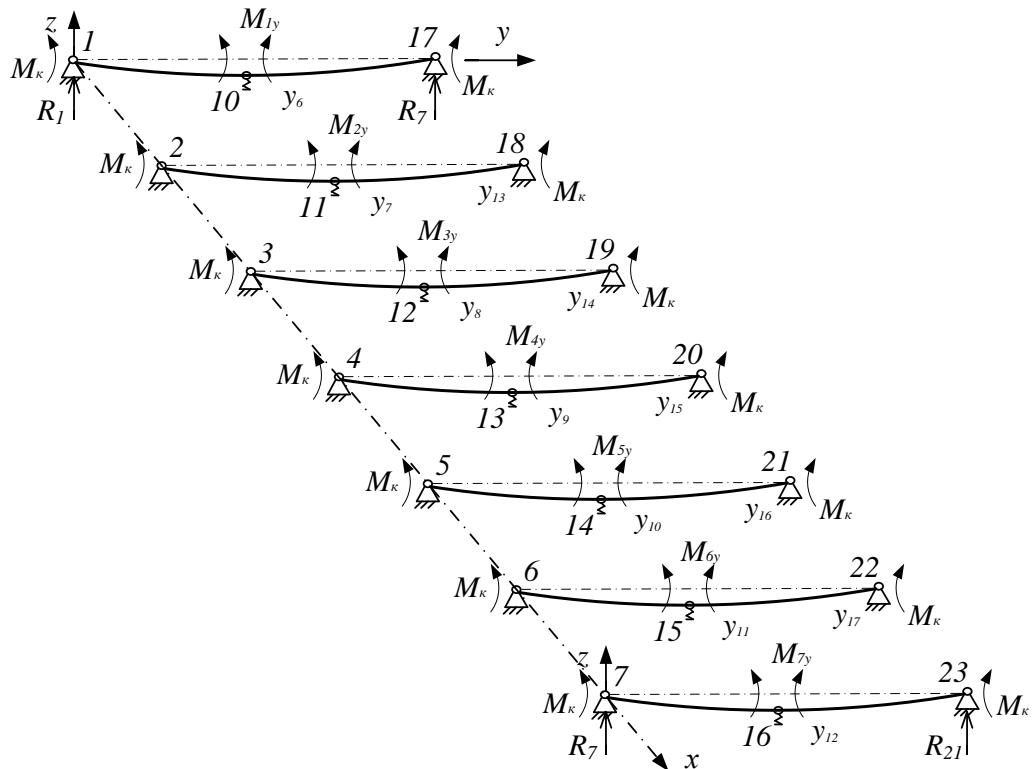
Розрахункова схема залізобетонних поперечних балок
